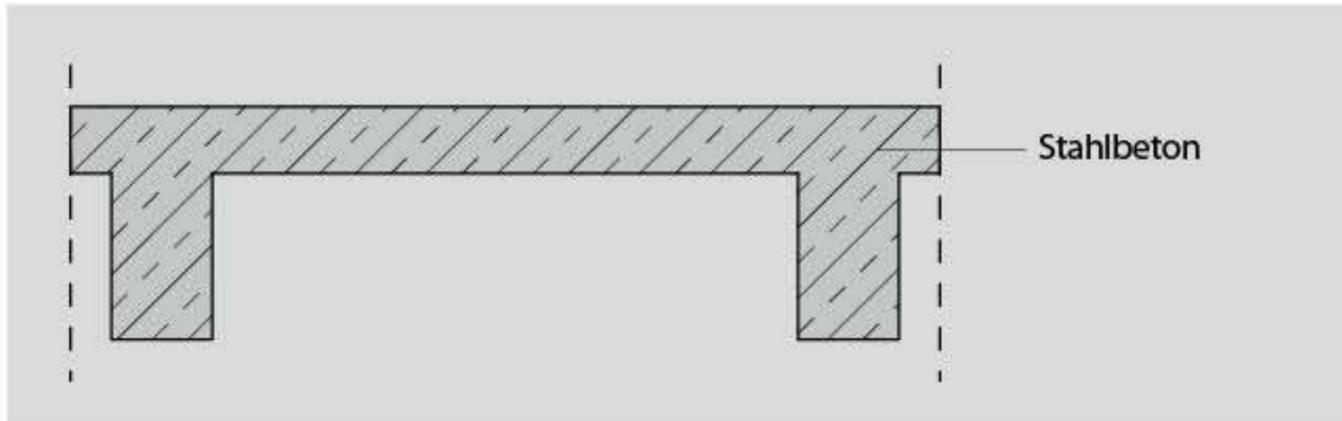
Stahlbetonrippendecke mit sichtbaren Balken
